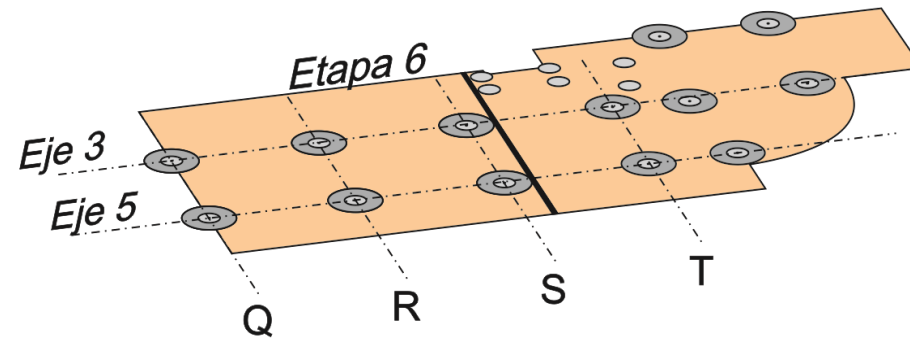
Vista en planta del sistema de cimentación de la Etapa 6
